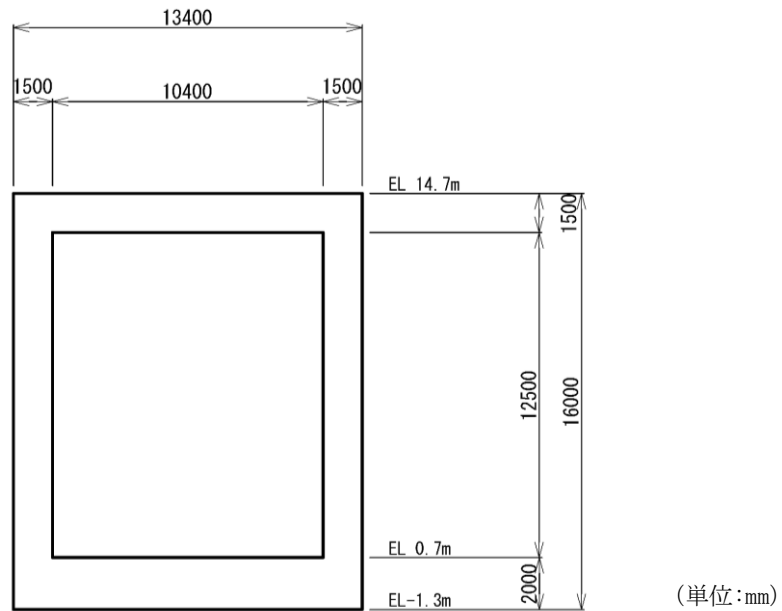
低圧原子炉代替注水ポンプ格納槽 断面図 (B-B断面)
